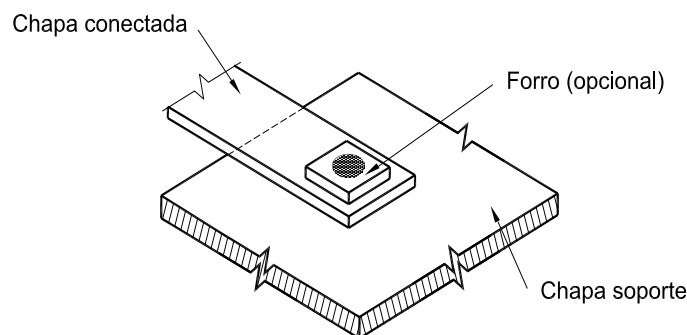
a. Soldadura de arco por puntos con forro
